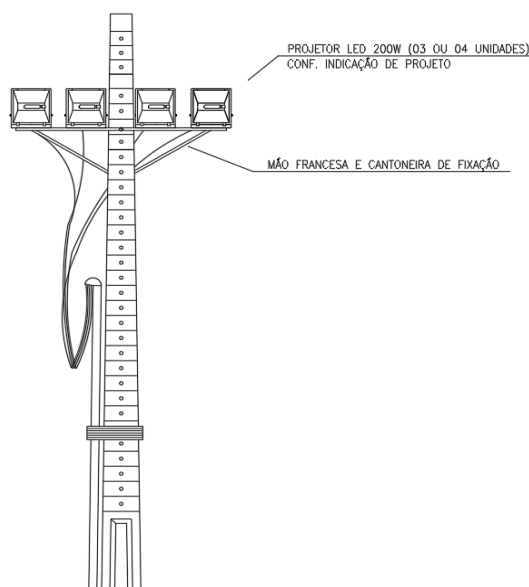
Conjunto de Iluminação em Poste de Concreto de 14 metros
